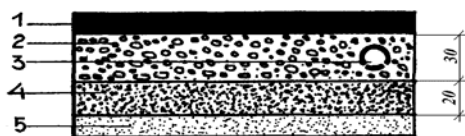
Схема конструкции прифундаментного дренажа с печанно-гравийном фильтром: 1 — пол подвала; 2 — гравий или щебень; 3 — труба поперечной дрены; 4 — крупнозернистый песок; 5 — местный грунт
